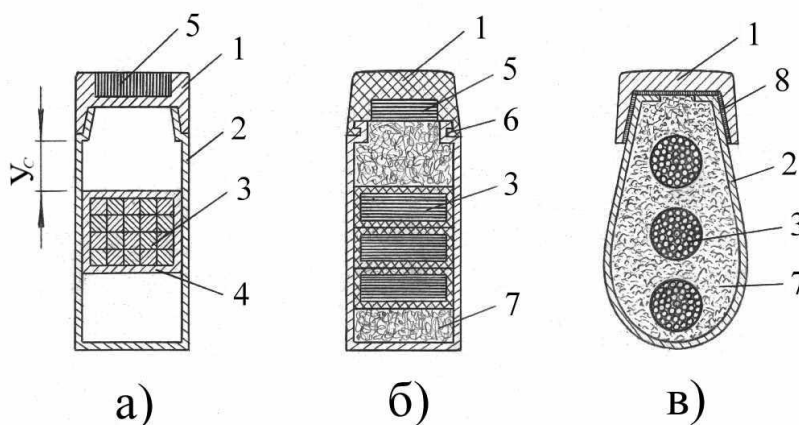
Варианты конструкции рельс-струны: а) со струной из проволок; б) из лент; в) со струной-канатом; 1 – головка рельса; 2 – корпус; 3 – струна; 4 – защитная оболочка струны; 5 – дополнительная струна; 6 – замк-защелка; 7 – наполнитель; 8 – клей.
